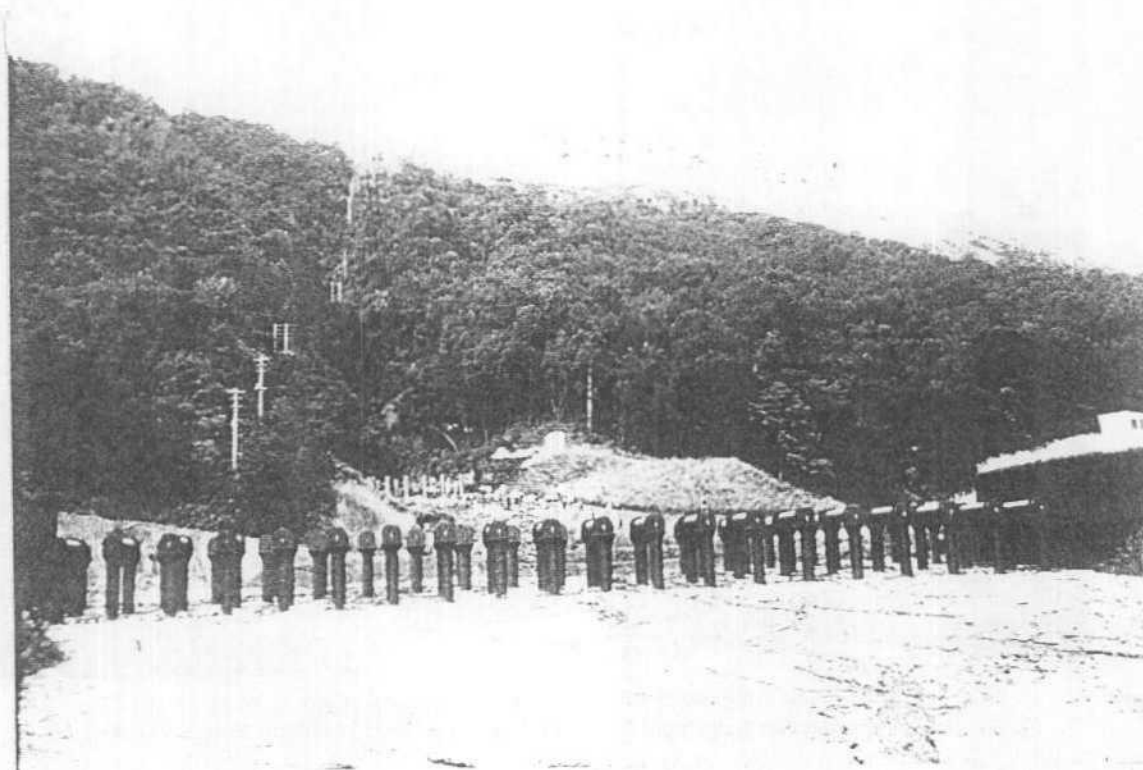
III.5.- Barreras instaladas en valles próximos al domo Showa Shinzan (al fondo), para mitigar el efecto de posibles lahares. Foto V. Araña.
